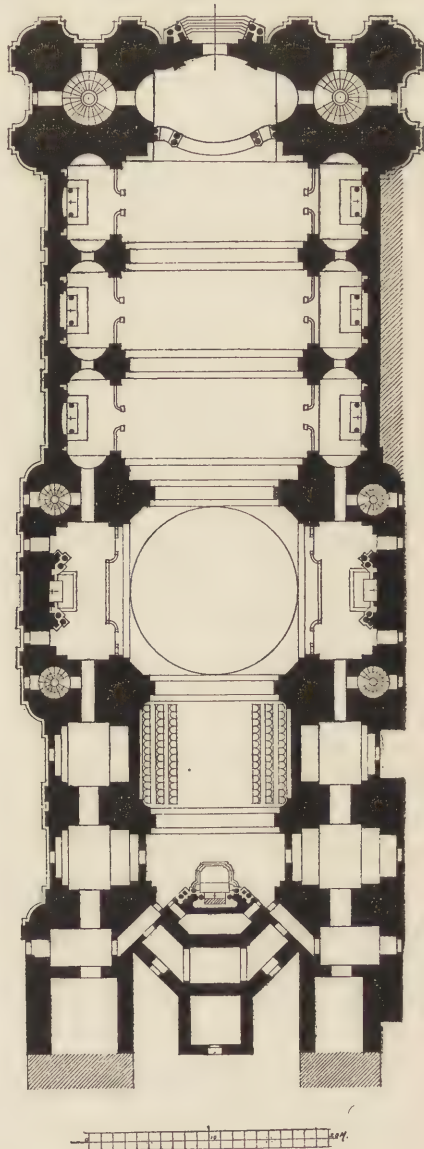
Kloster Melk. Grundriss der Kirche.
